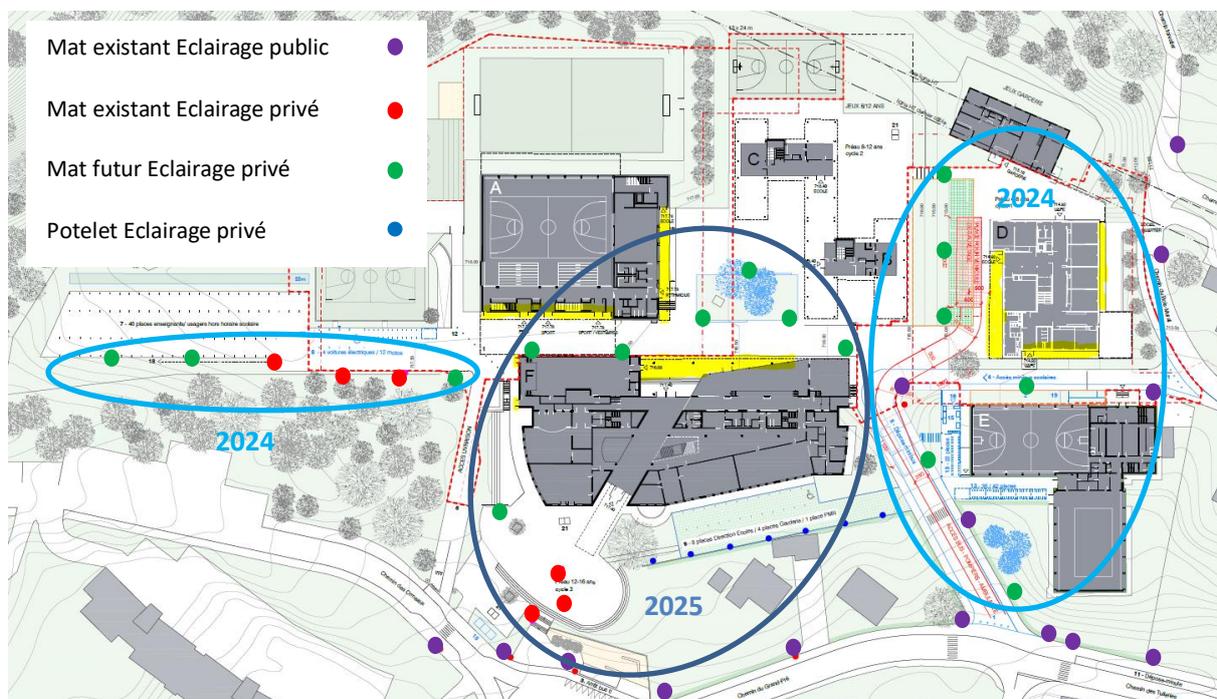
Plan de situation des secteurs concernés par les travaux d'éclairage public
